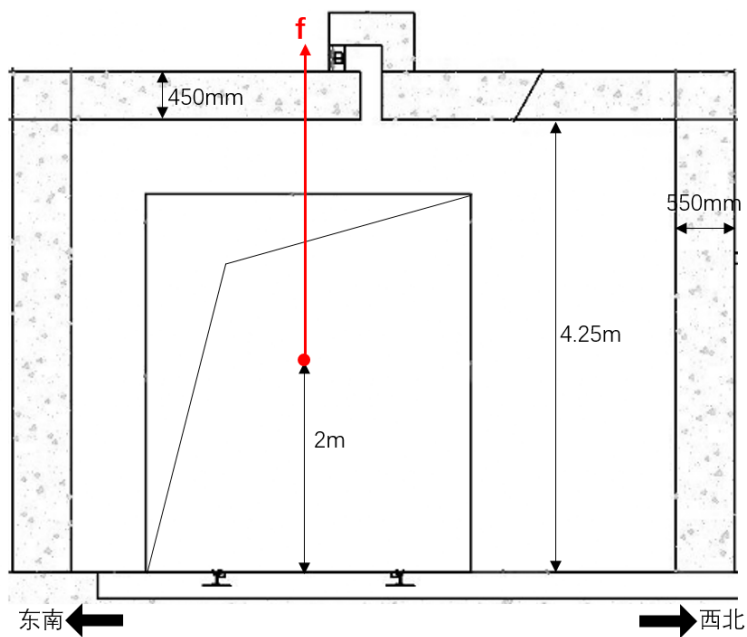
辐射屏蔽计算预测点位剖面图 (单位: mm)
